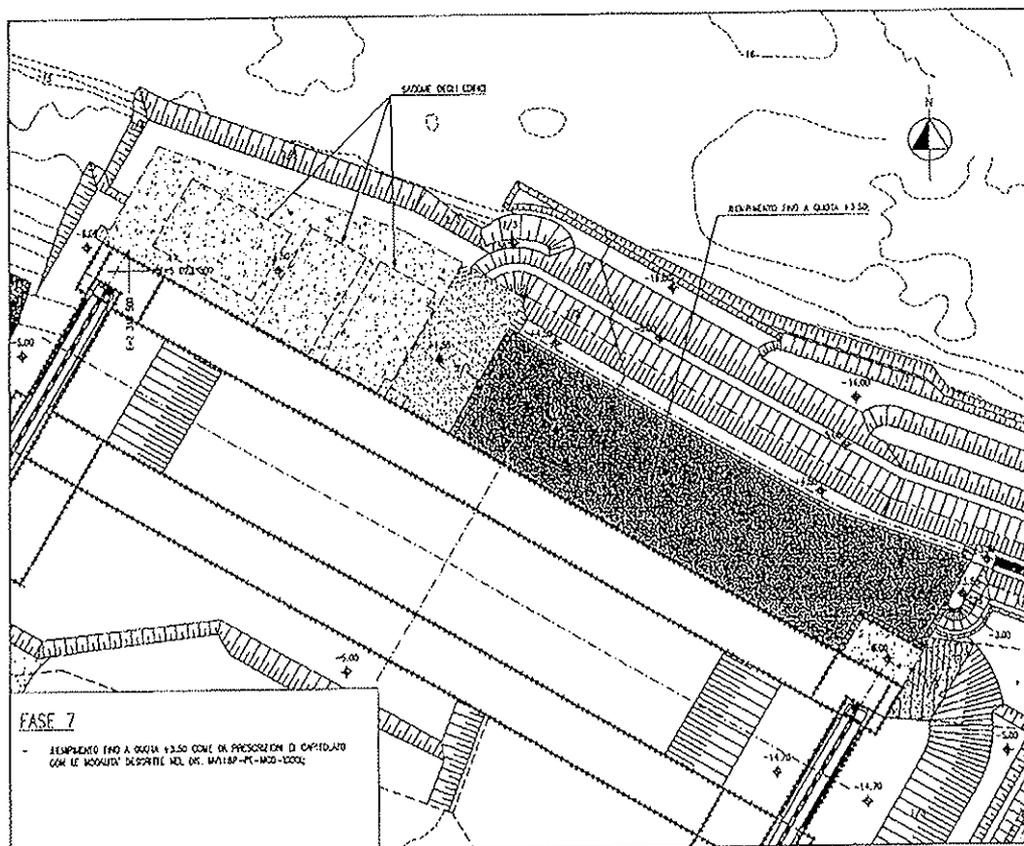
SPALLA LATO SUD - WBE MA.G1.31.PE.01, PLANIMETRIA
